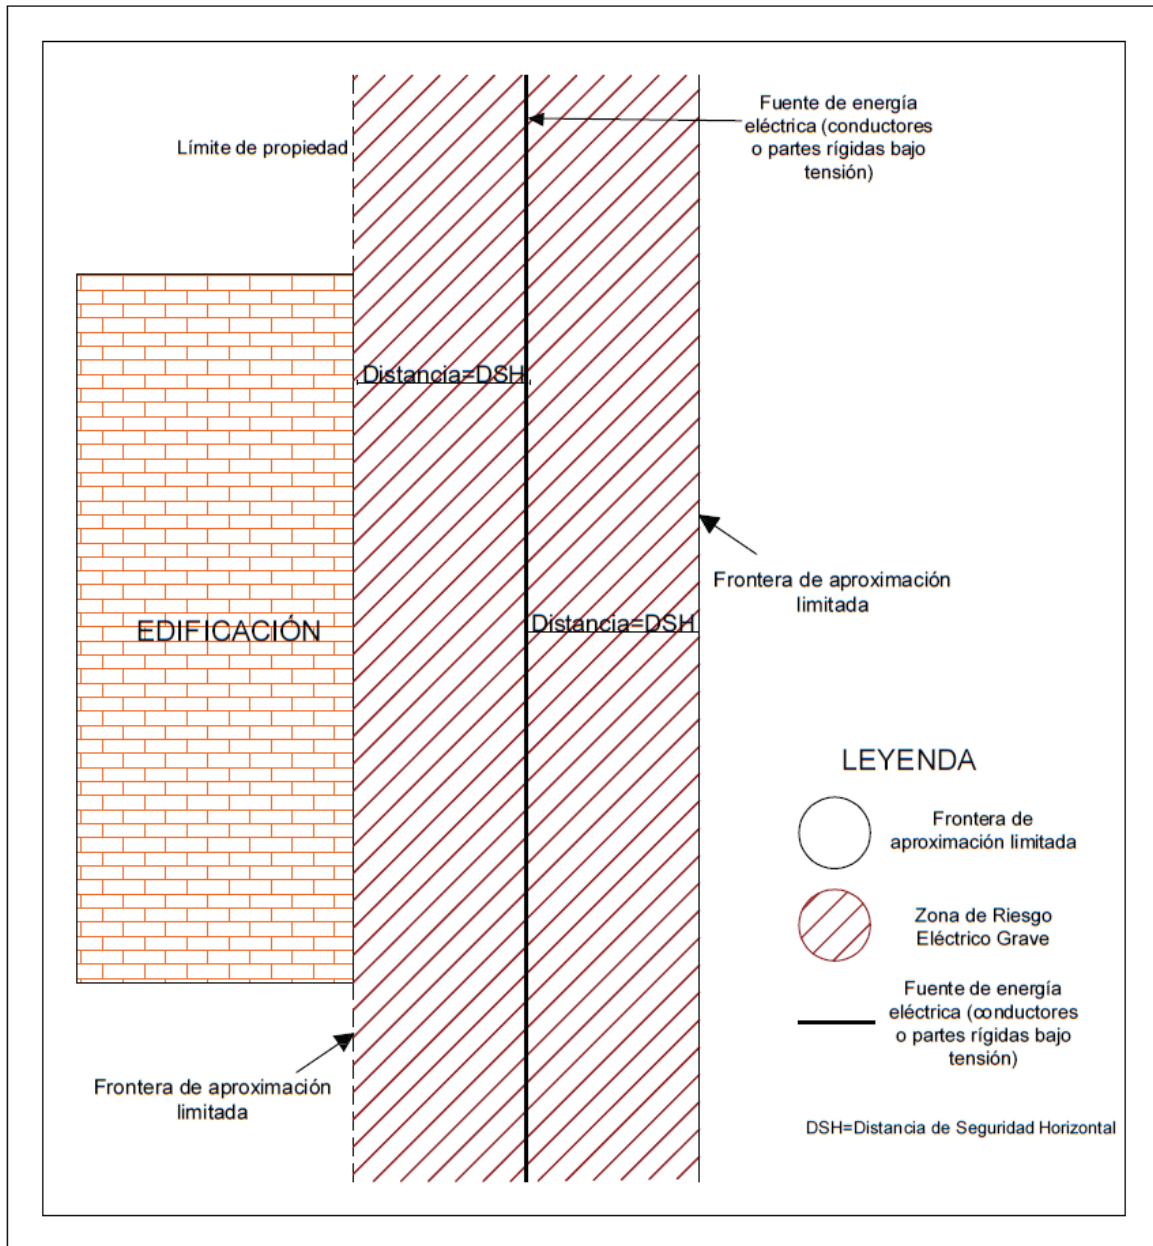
Delimitación de la Zona de Riesgo Eléctrico Grave – vista de planta
